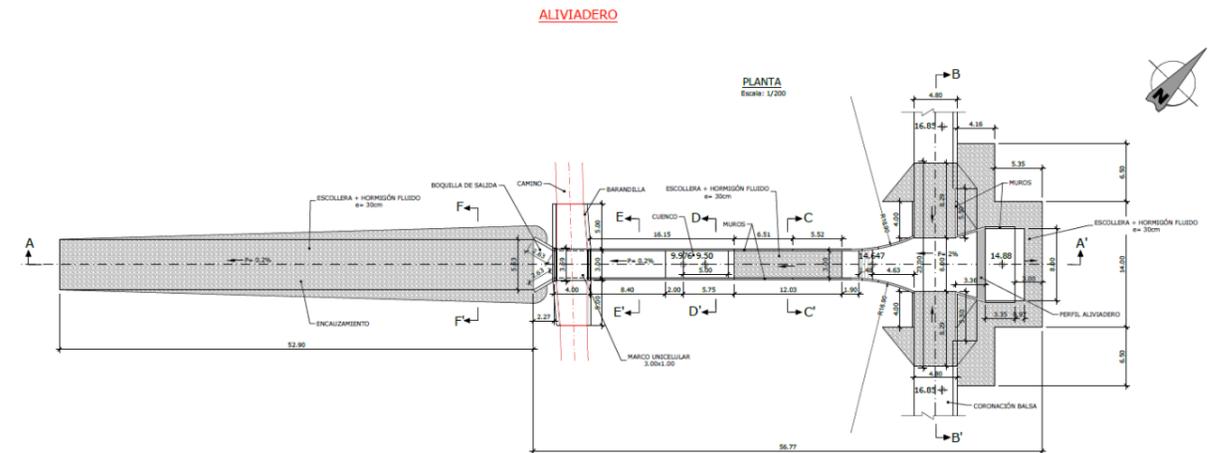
Aliviadero balsa de regulación. Planta. S, Alcantarillas
